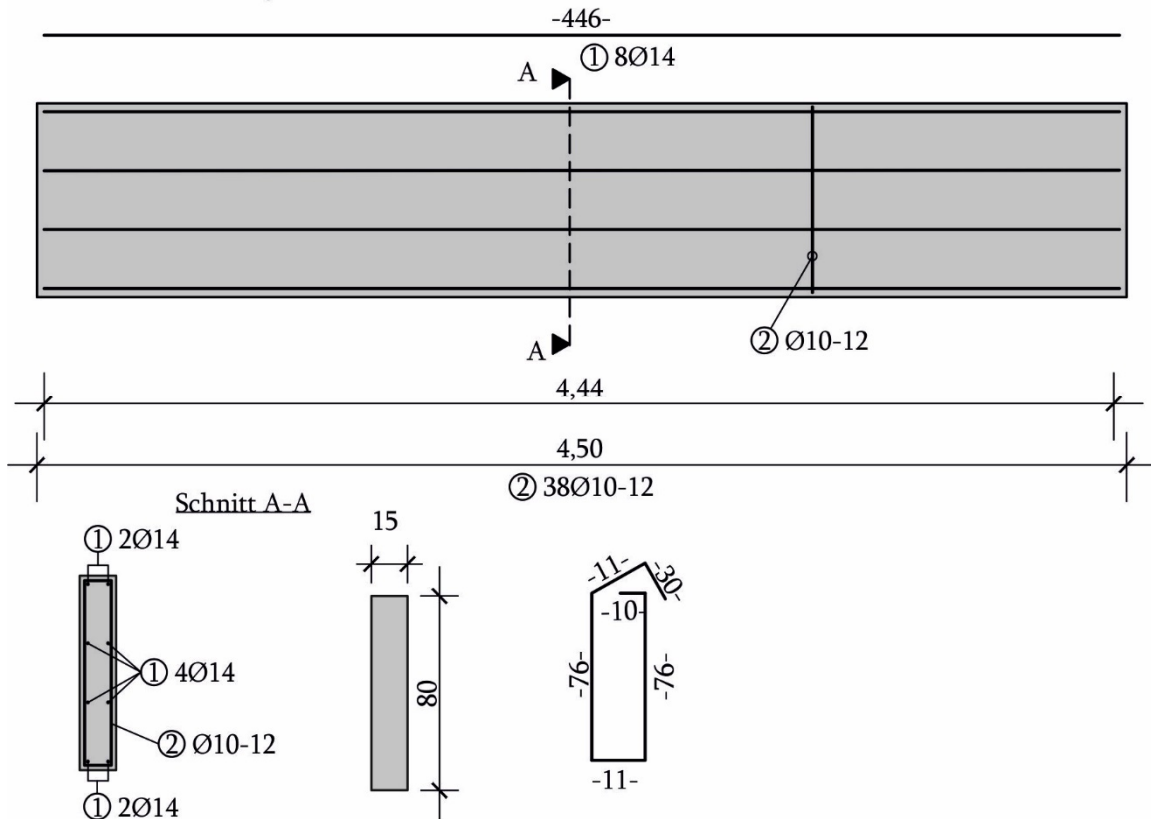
Schal- und Bewehrungsplan des Balkens B9 (Balkentyp IV)
